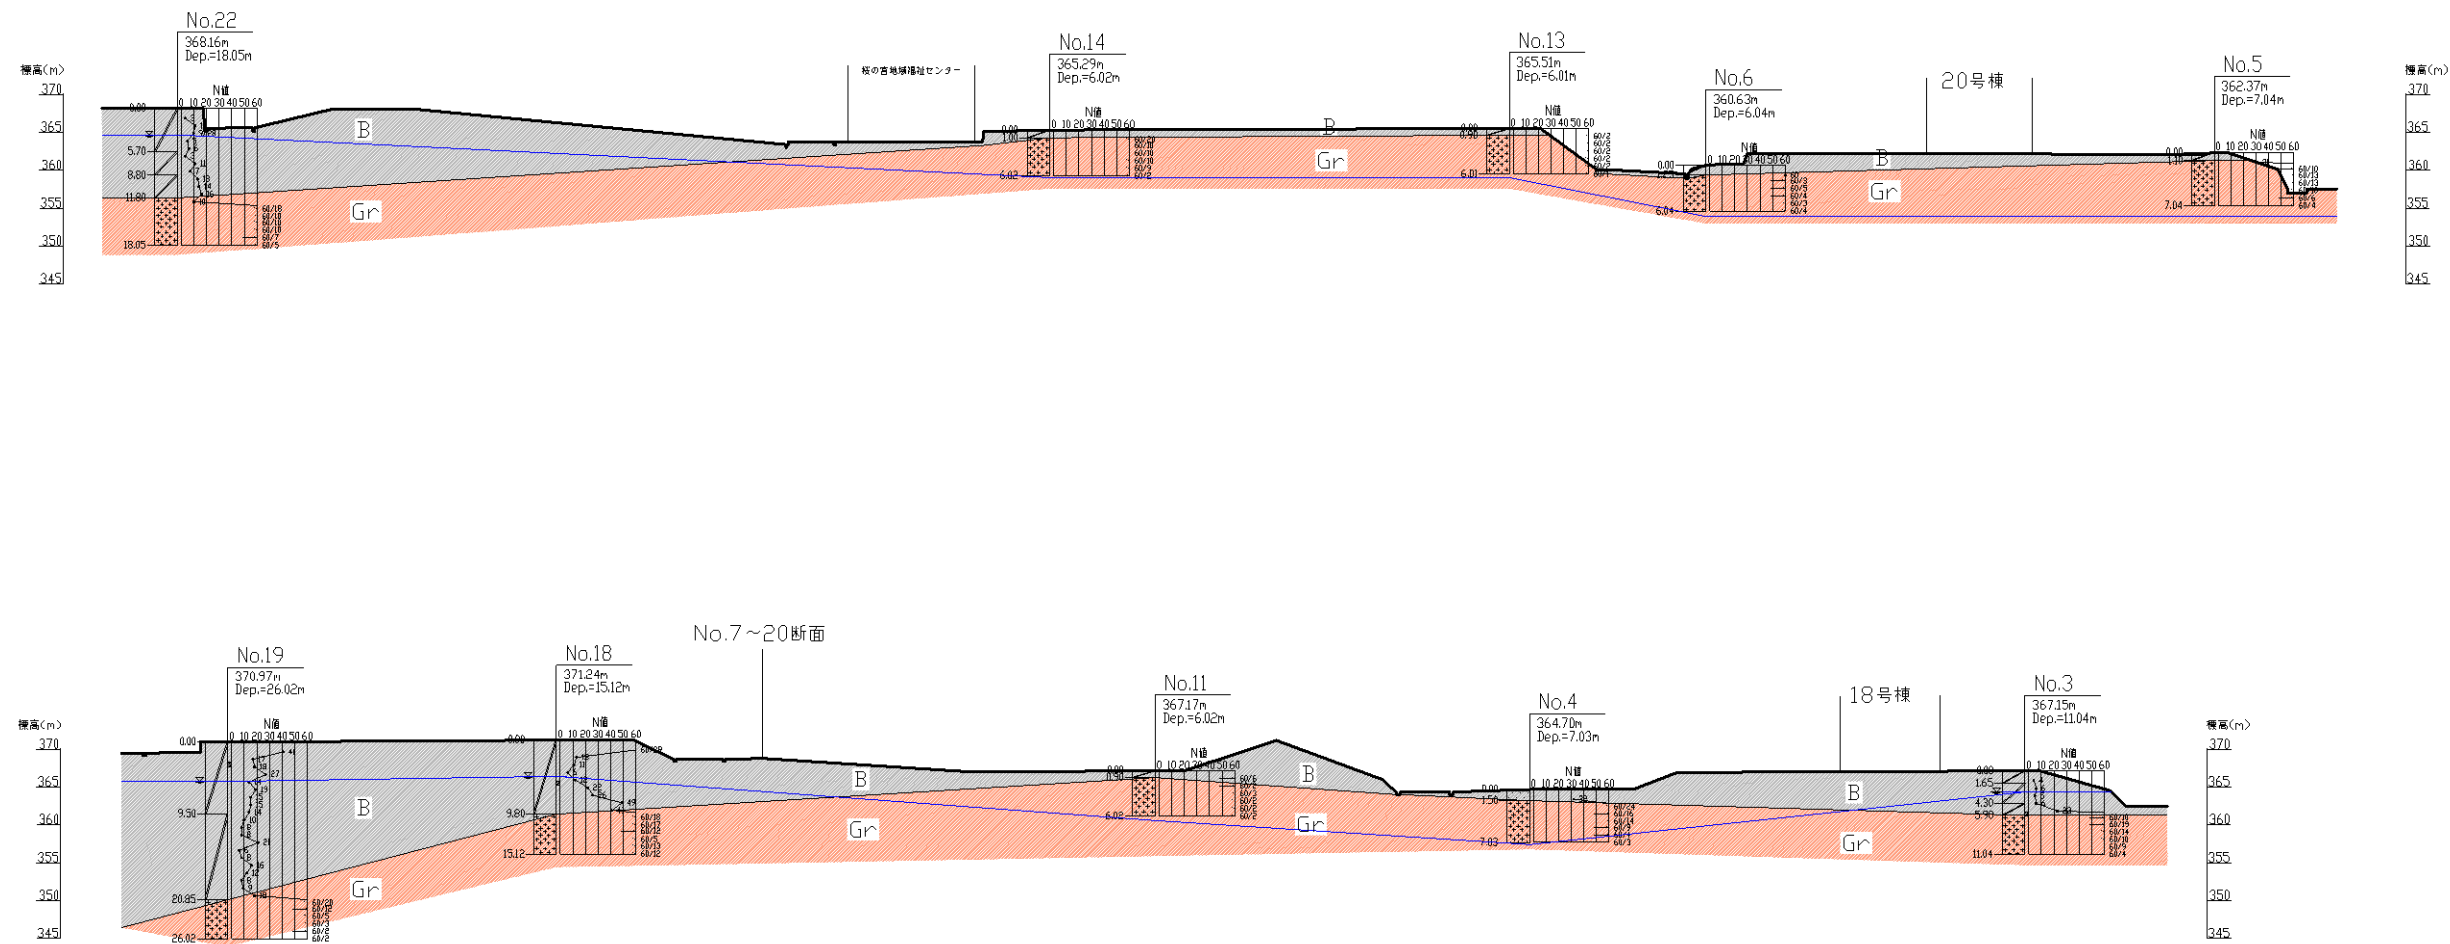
推定地質断面図 (No. 22~5、No. 19~3) (S=1/1000:A3)
